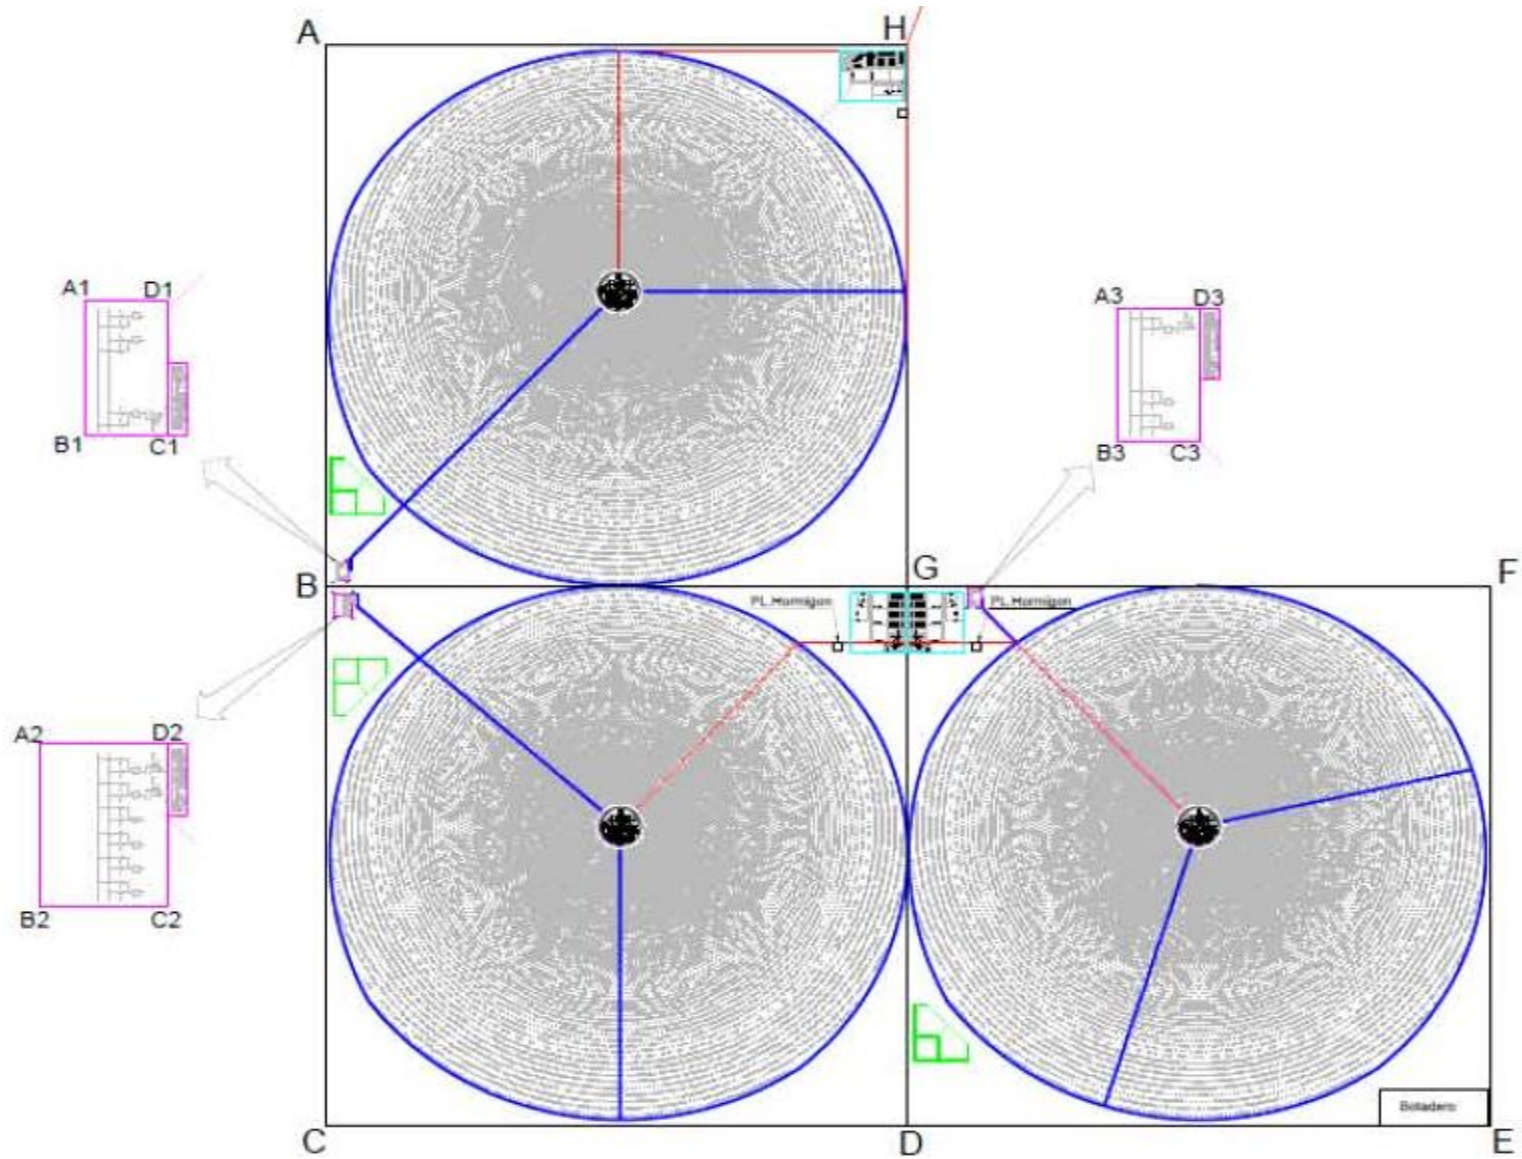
Plano localización de proyecto planta solar Likana Solar
